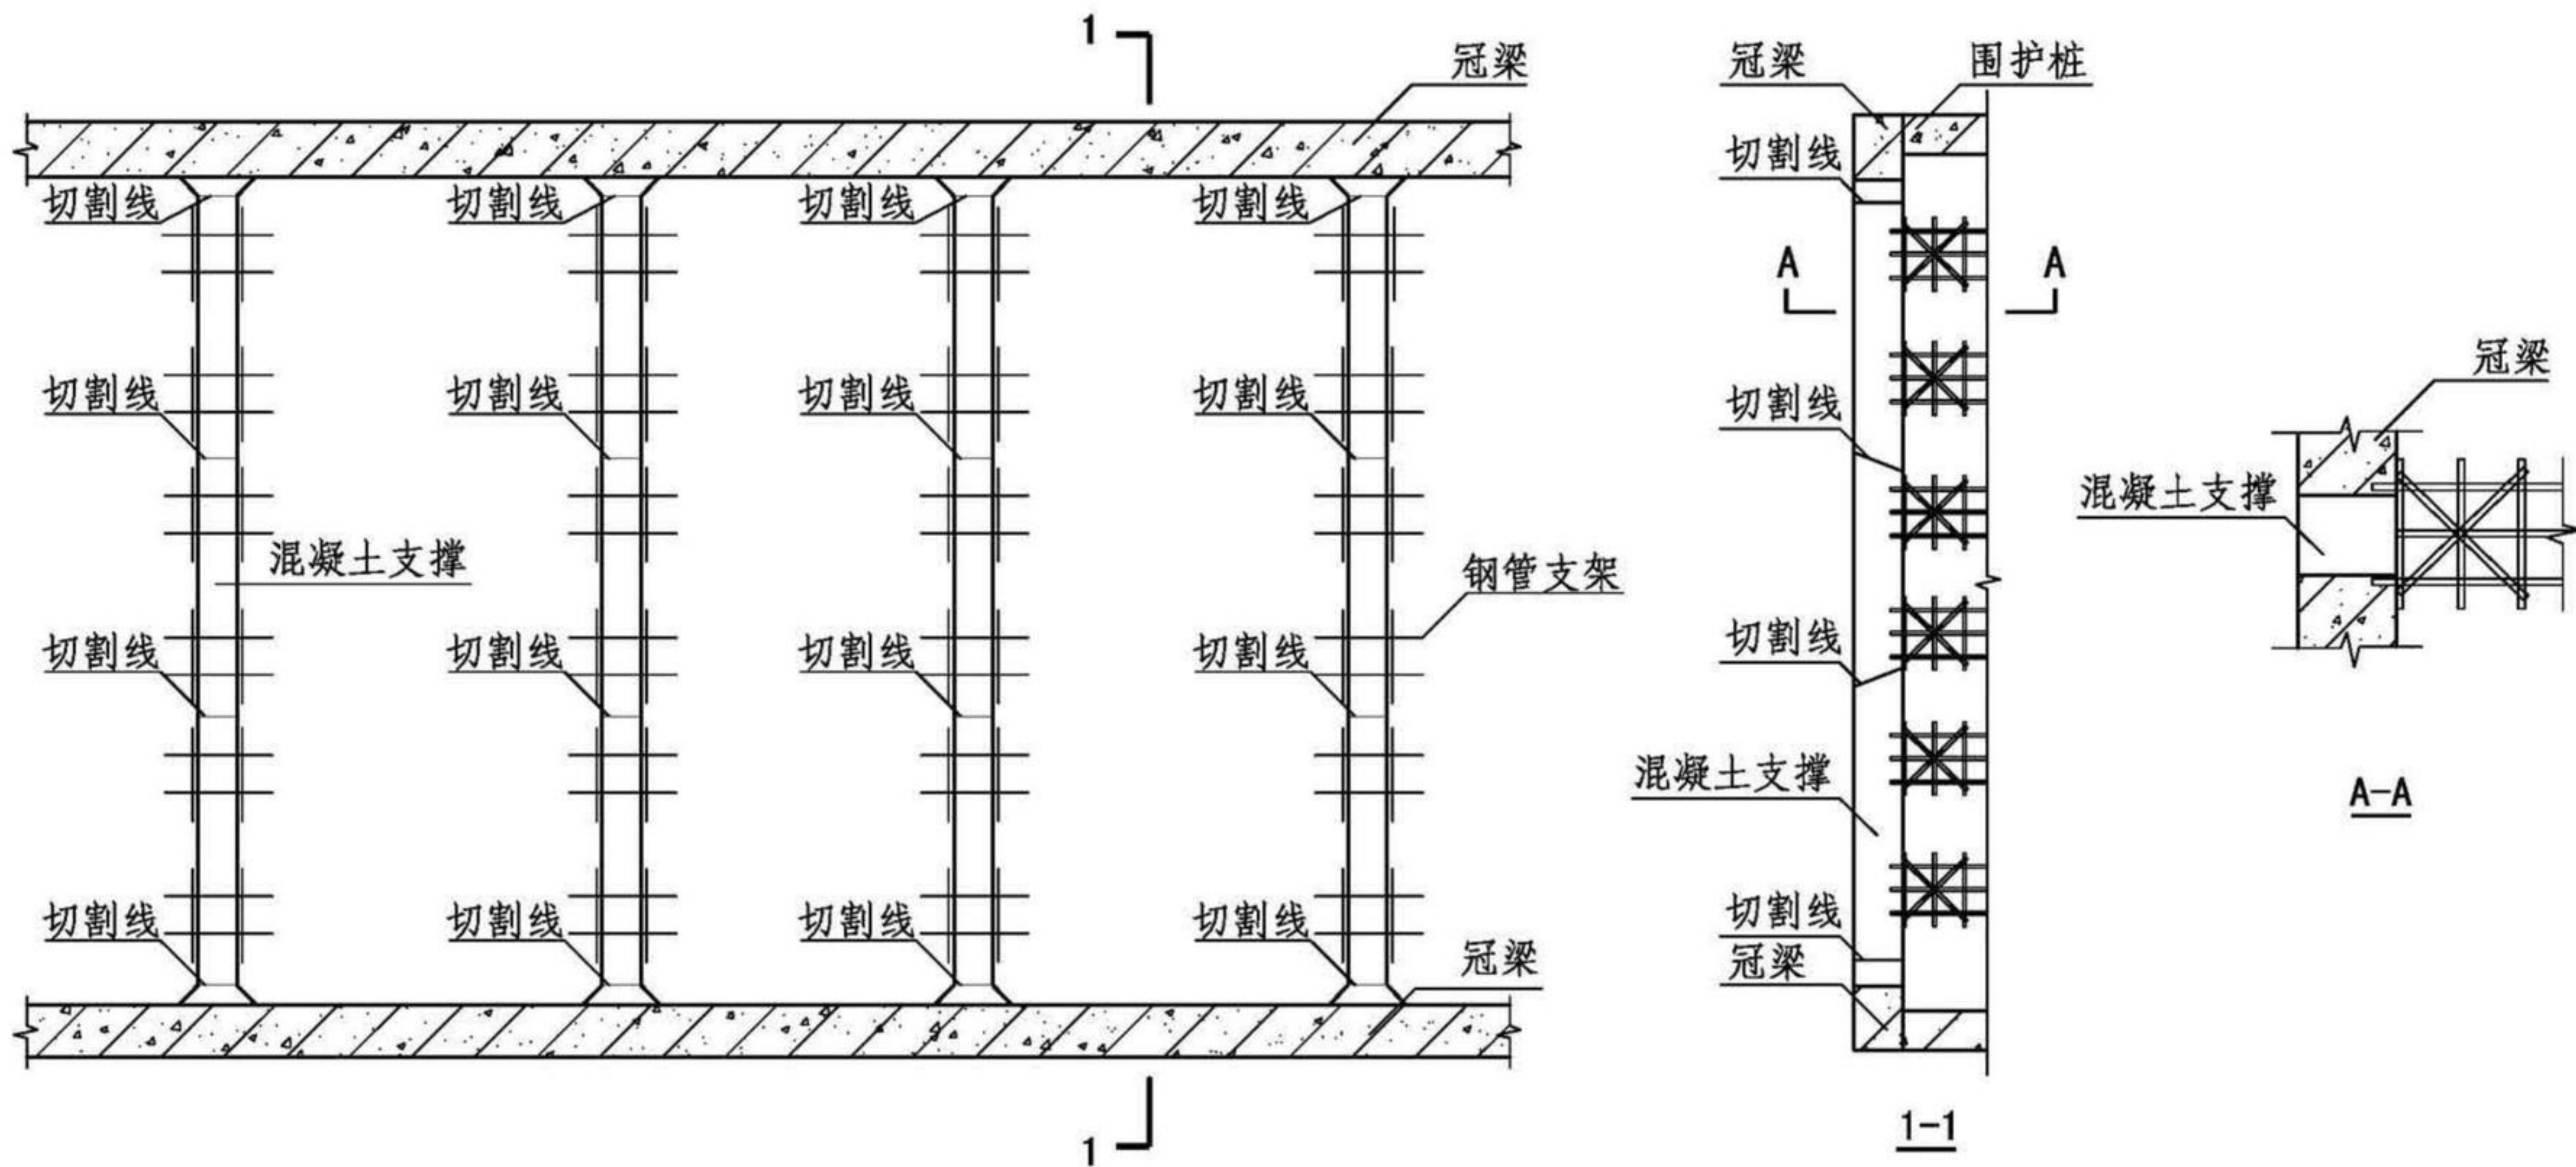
混凝土支撑拆除支架搭设及切割位置示意图
